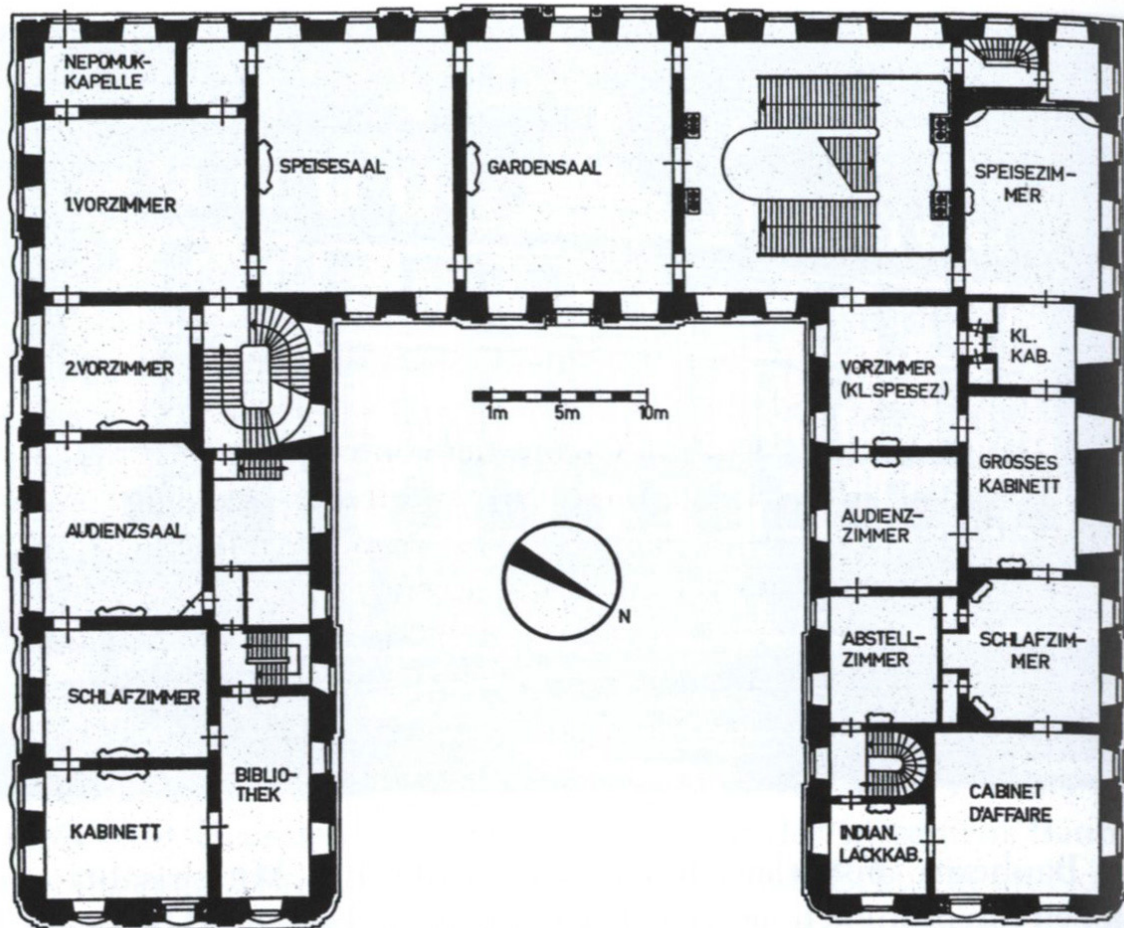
Grundriss des Obergeschosses von Schloss Augustusburg mit der Reihenfolge der Zimmer und den Enfiladen
